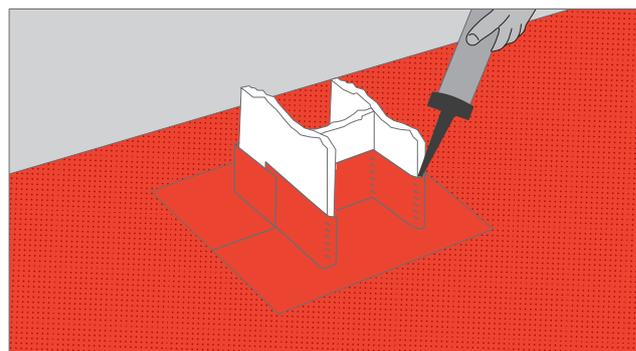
Encuentro de la barrera tipo lámina con un pilar
